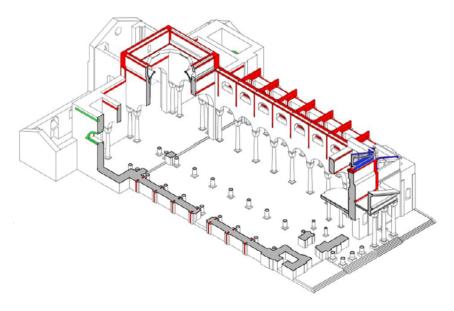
Serie axonométrica de la basílica con los refuerzos estructurales en hormigón armado de los tres períodos
